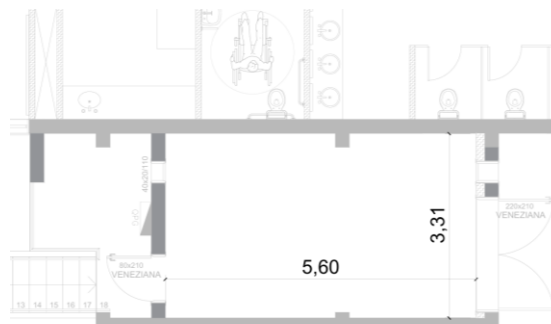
Sala da Subestação – Planta Baixa, escala: 1/50 – Fonte: Elaboração própria
